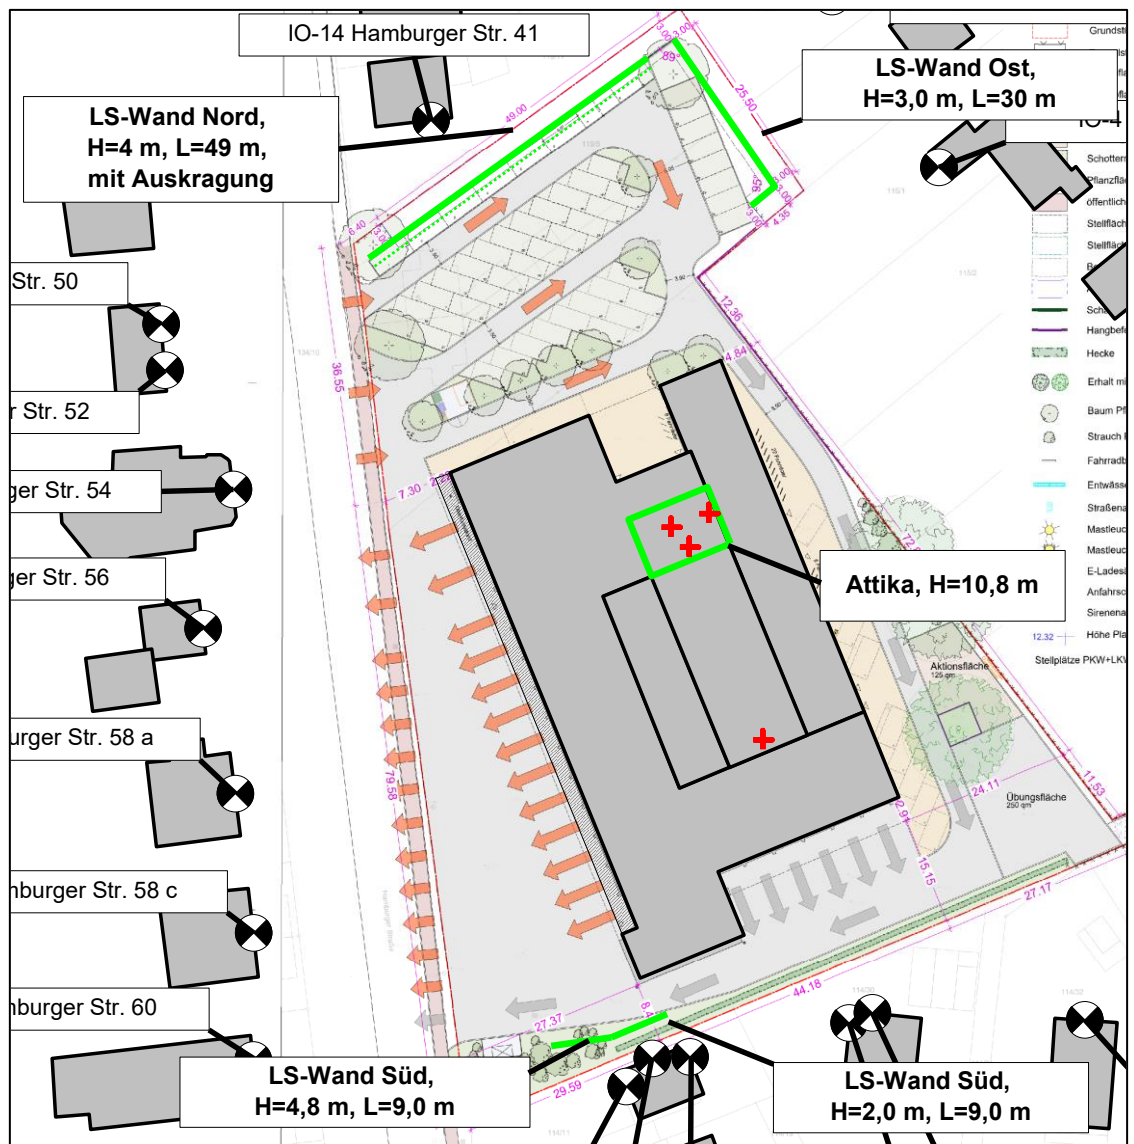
Lageplan mit geprüften Lärminderungsmaßnahmen [30].
